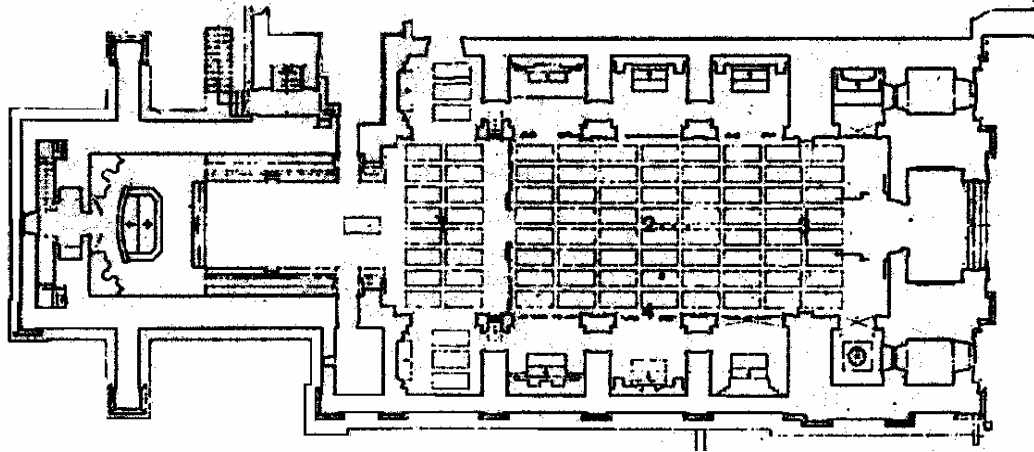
Planta da igreja do mosteiro de Tibães [3]
